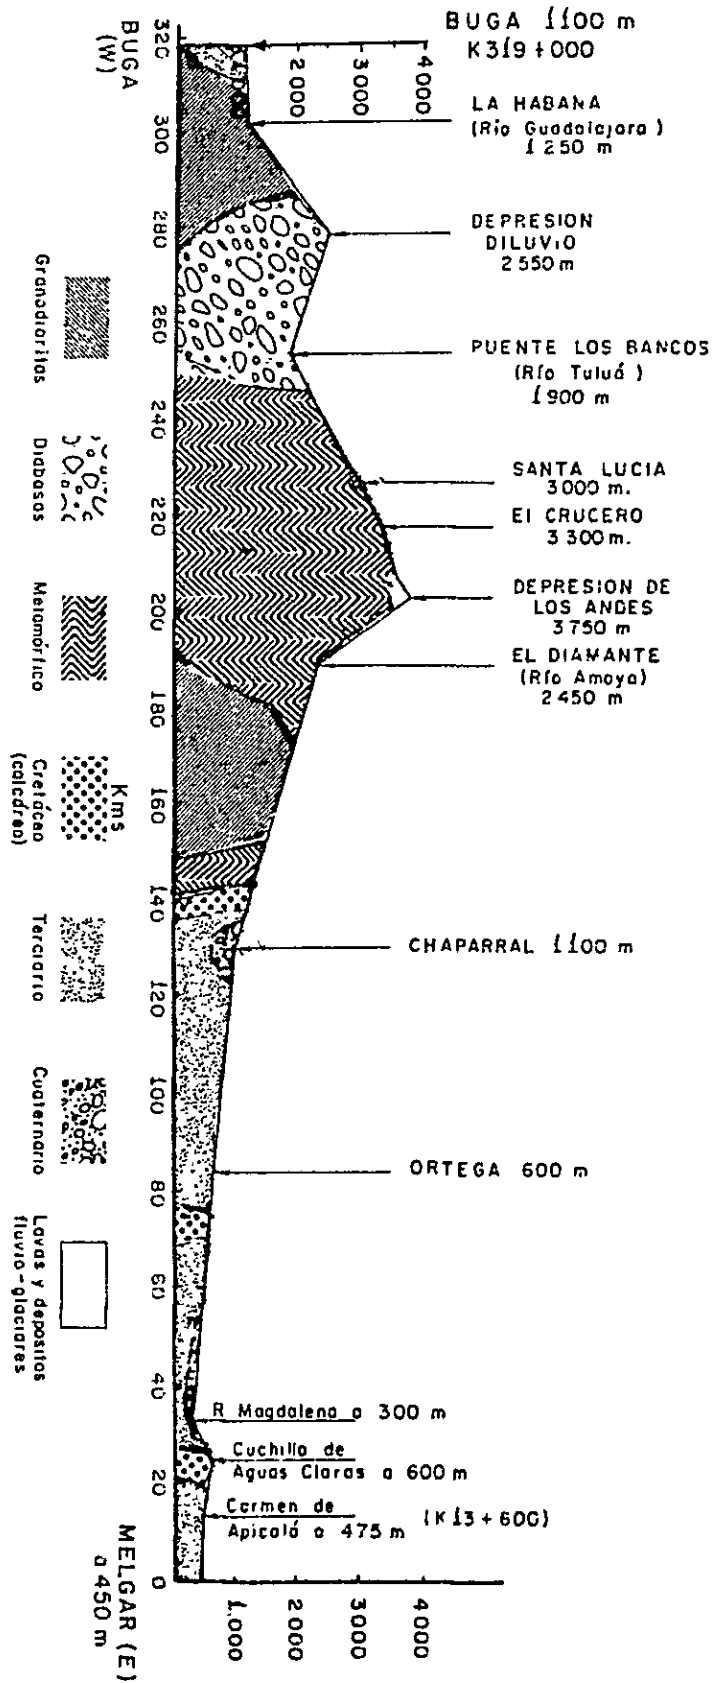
PERFIL LONGITUDINAL DEL PROYECTO MELGAR-BUGA - ALTERNATIVA 2
